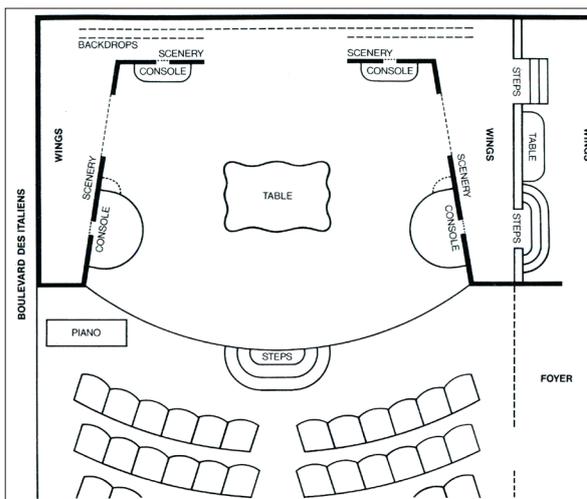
Grundriss des Bühnenraums¹¹²
